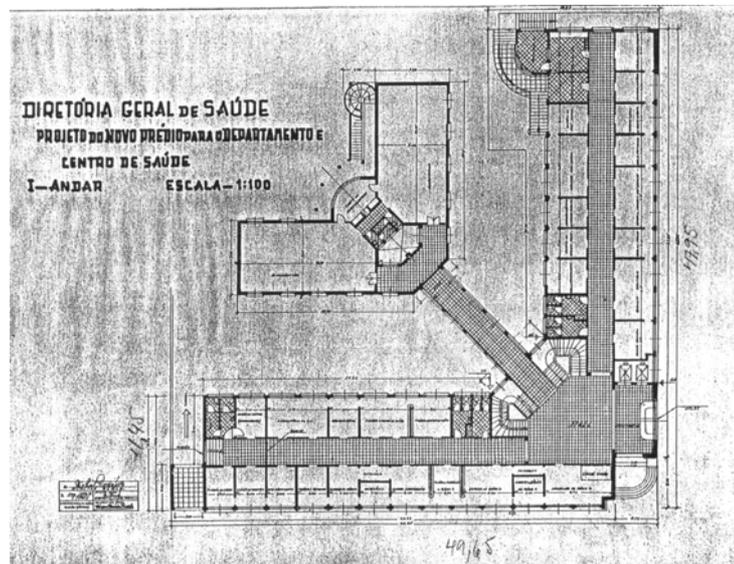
Edifício do Departamento de Saúde Pública do Paraná planta do pavimento térreo
